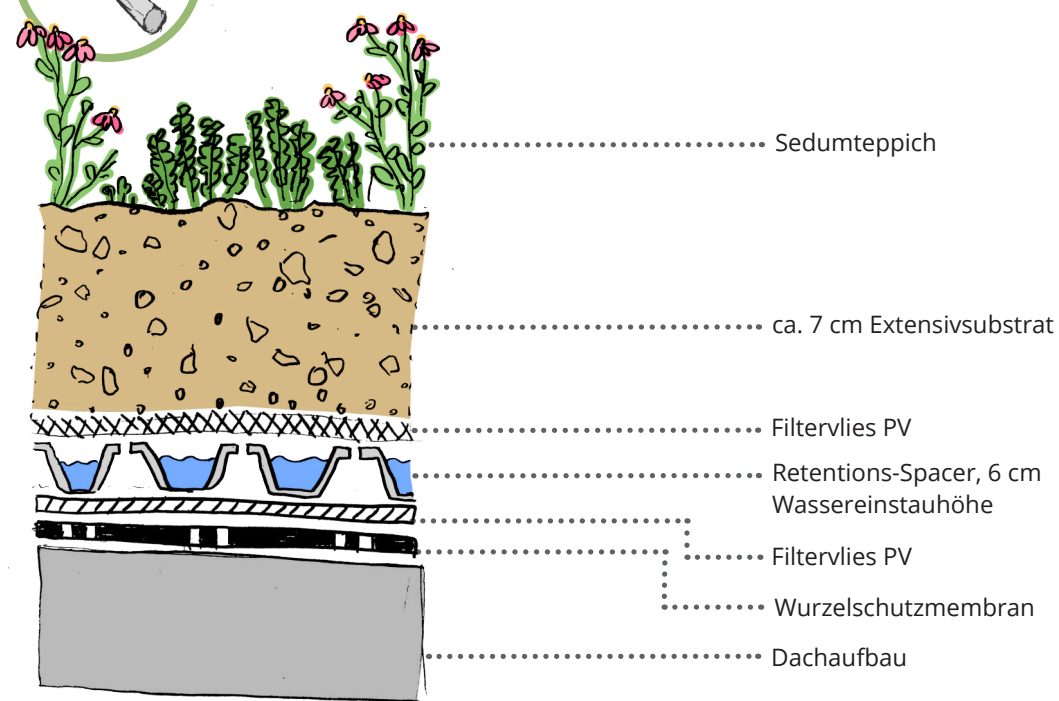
Systemaufbau Retentionsgründach extensive Dachbegrünung mit 6cm hohen Retentionsabstandshalter (TUD 2025 nach ZinCo b 2023: 7).
